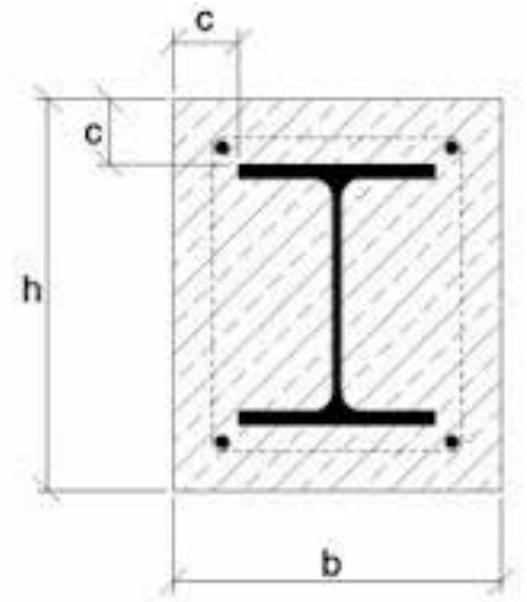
coupe schématique d'un poteau mixte (www.google.com)
